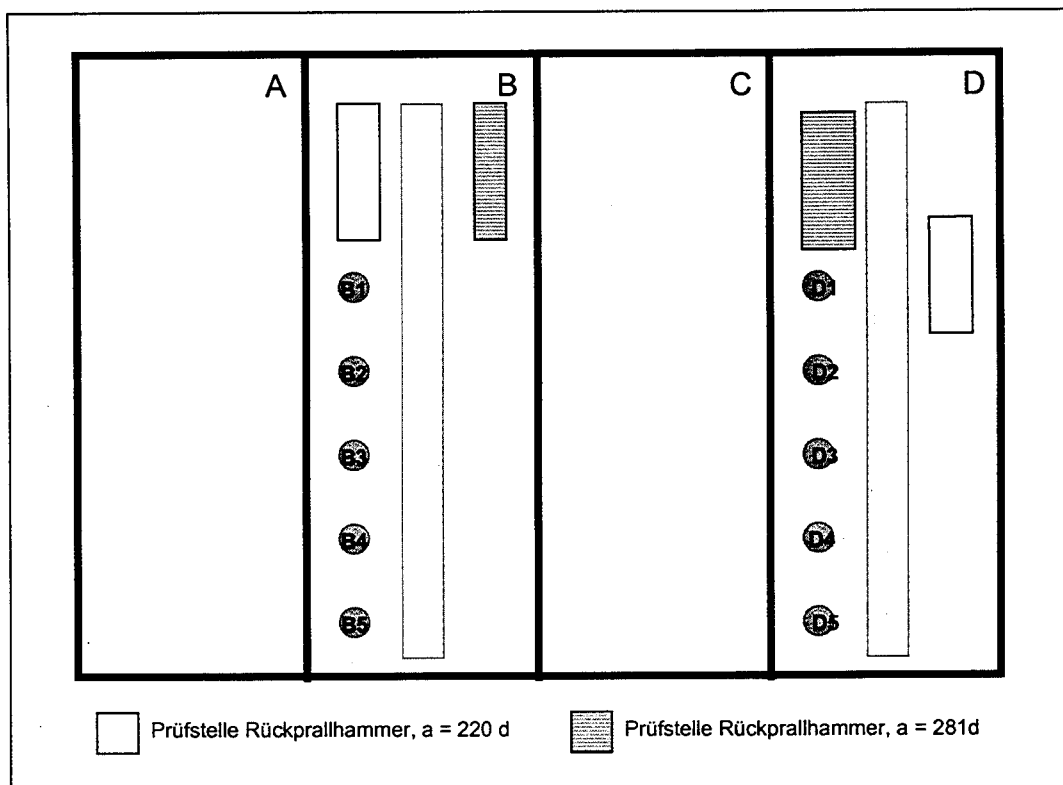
Lage der Prüfflächen am Betonkörper 21
